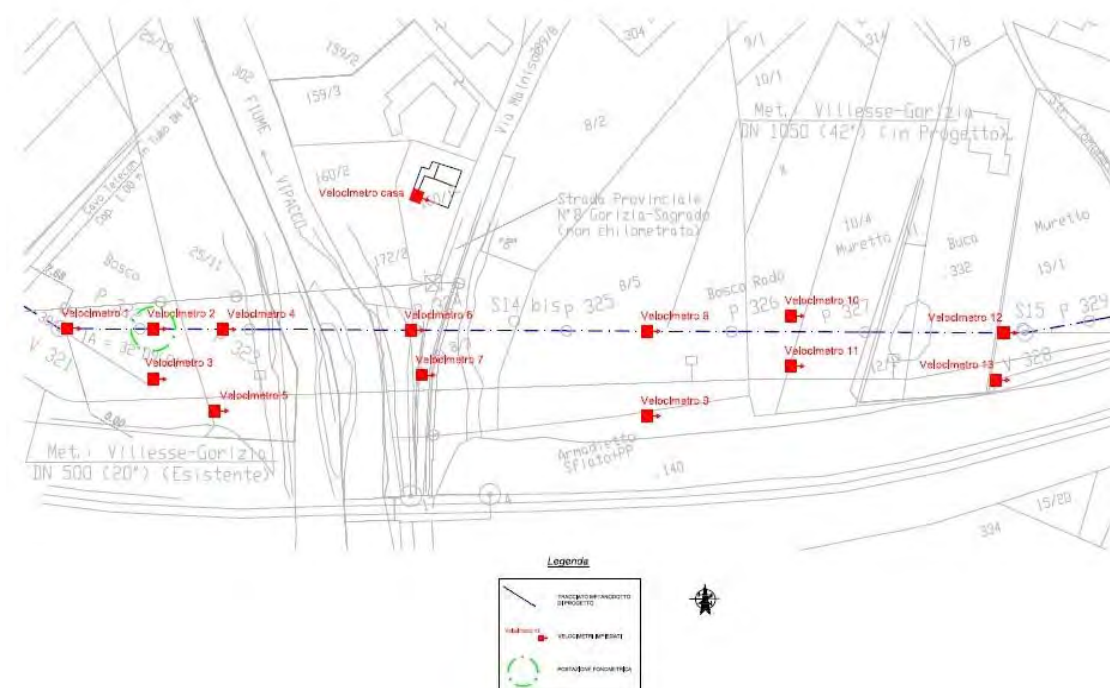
Planimetria dell'ubicazione dei velocimetri presso il cantiere di Vipacco(sopra)
